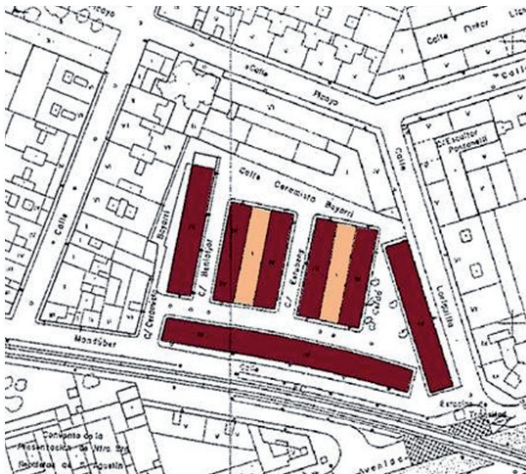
y 8. Grupo Alboraya. Planta de conjunto y planta tipo de viviendas
